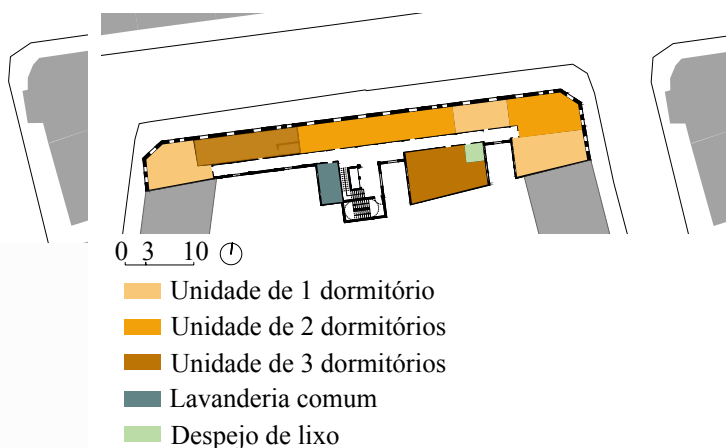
Planta proposta para os pavimentos superiores com divisão de usos.
